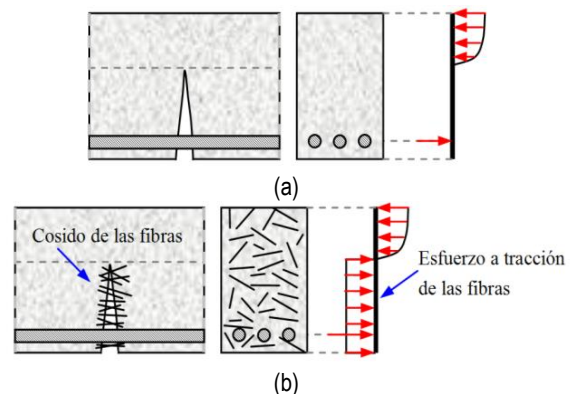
Distribución de tensiones [12]: (a) Concreto armado sin fibras de acero, (b) Concreto armado reforzado con fibras de acero.
